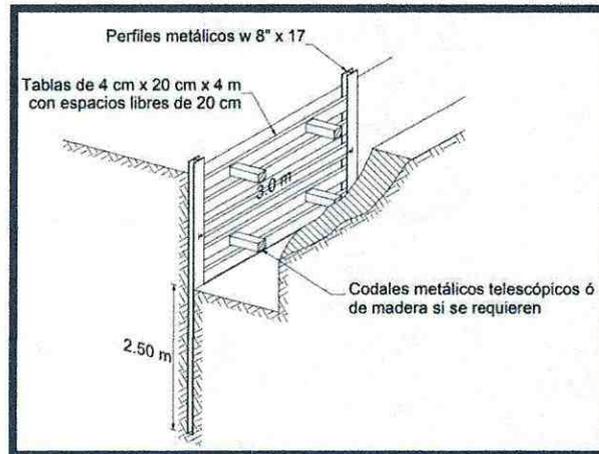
Esquema típico de entibado tipo 1ª alternativo
